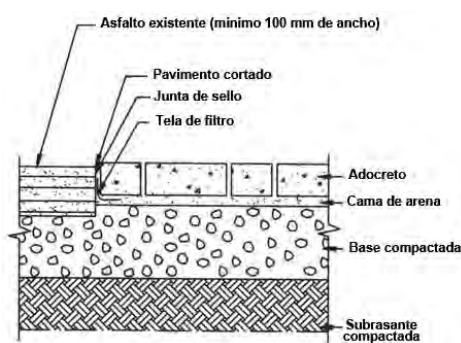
UNIÓN CON PAVIMENTO DE ASFALTO EXISTENTE
